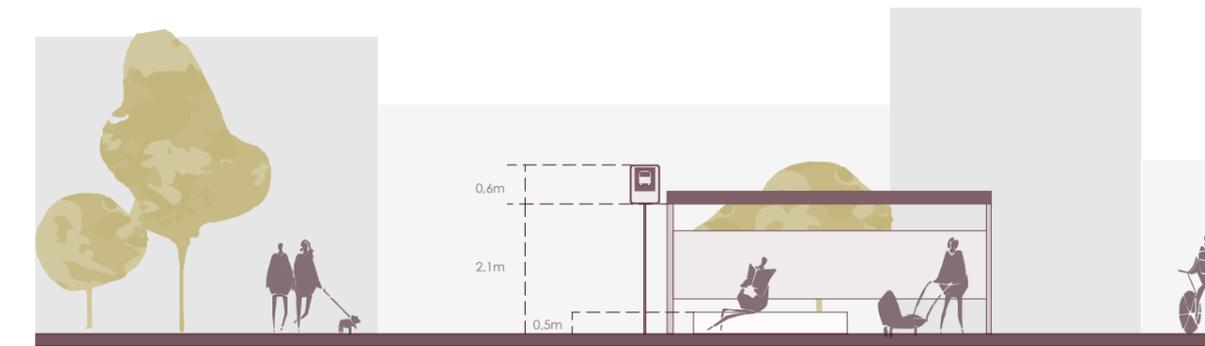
Planta Franjas de servicio - *Elaboración propia
